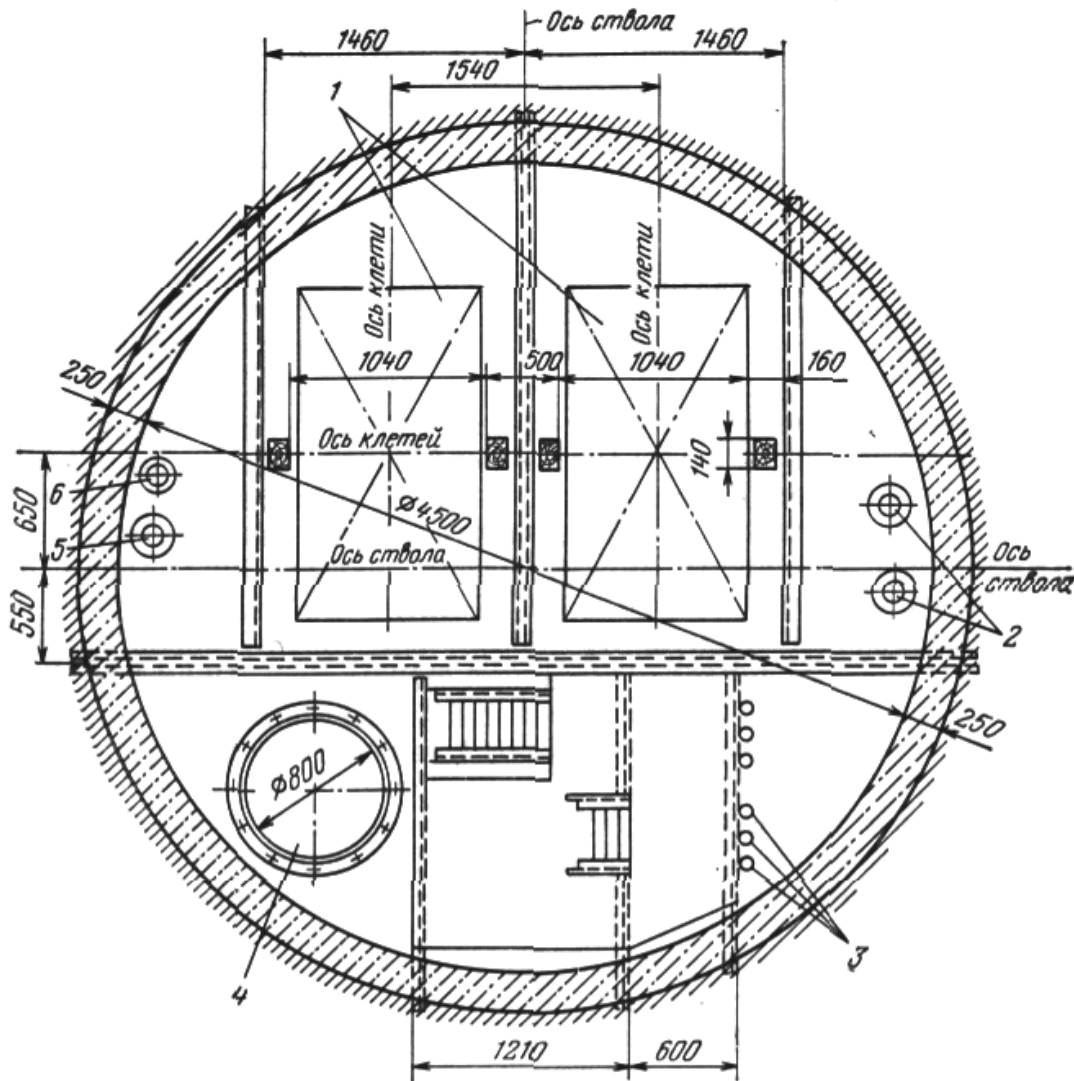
Типовое круглое сечение ствола разведочной шахты диаметром 4,5 м: 1 – шахтные клетки; 2 – трубы для водоотлива; 3 – электрические кабели; 4 – вентиляционный трубопровод; 5 – труба для подачи сжатого воздуха; 6 – трубопровод водоснабжения
